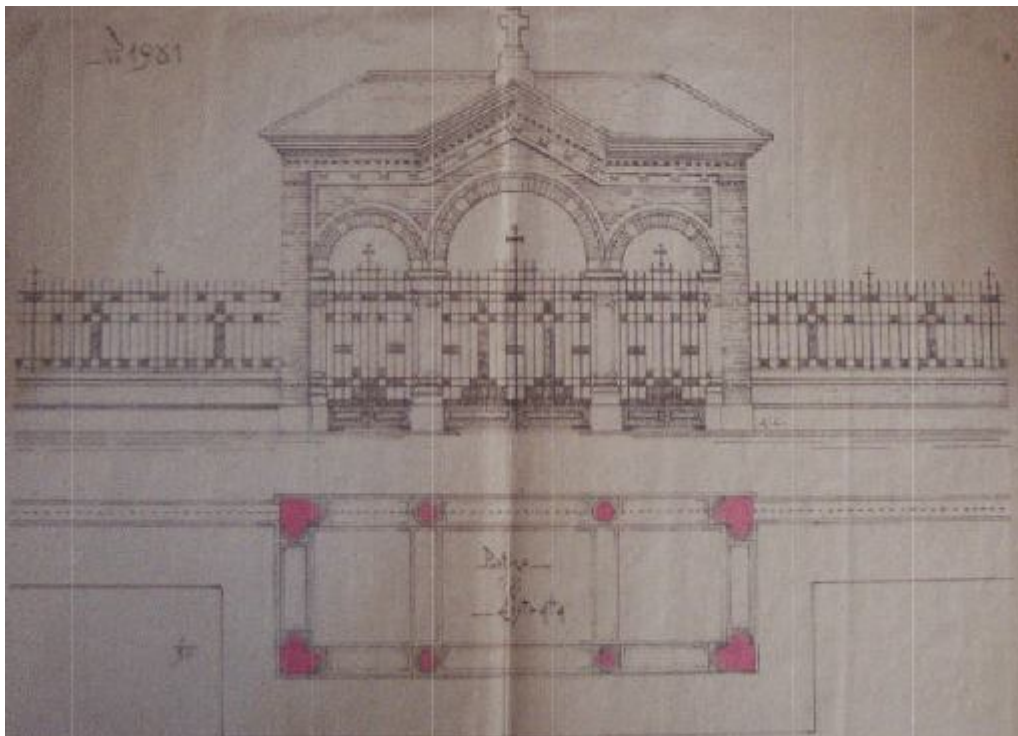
Ingresso principale cimitero – prospetto e pianta.
